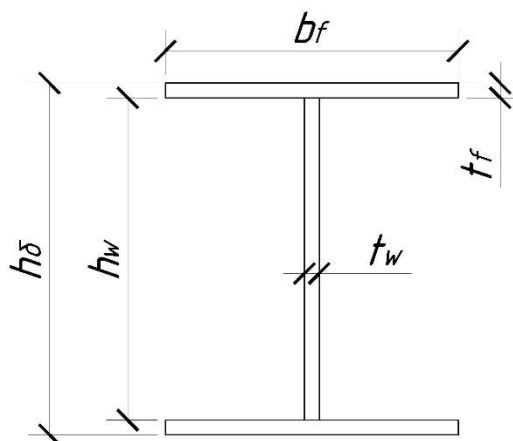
Поперечний переріз поздовжньої балки
